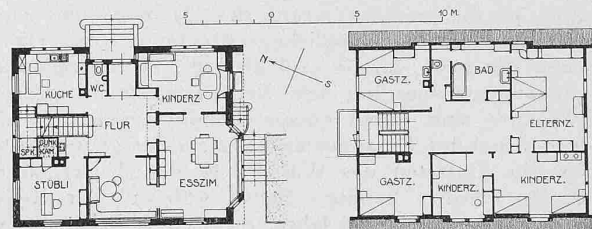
u. 2. Einfamilien-Wohnhaus Stoffel-Saurer. — Grundrisse 1:400.
